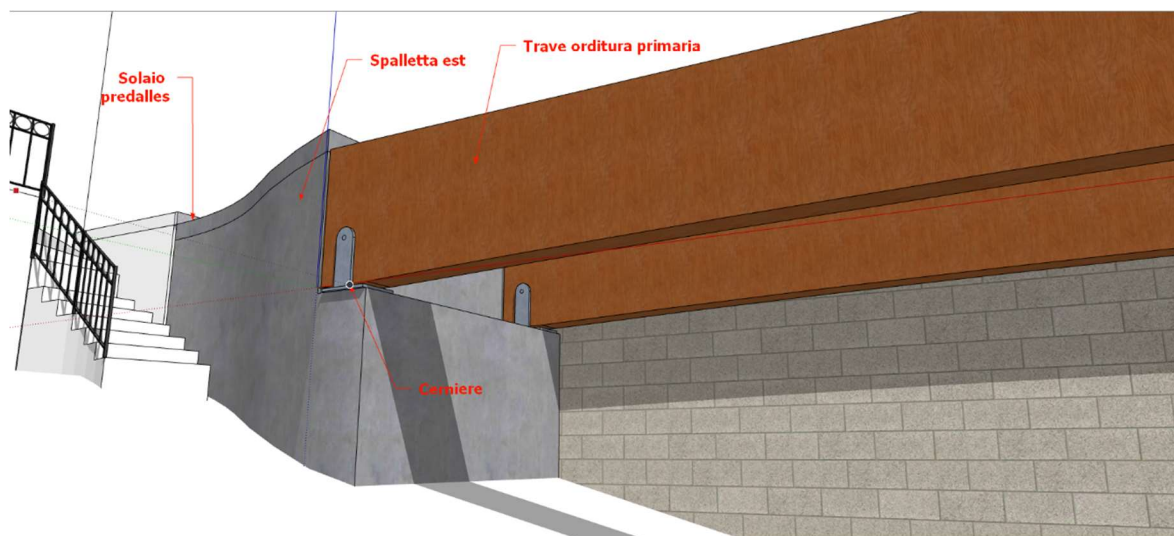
Appoggio delle travi principali sulla spalletta est su cerniere
